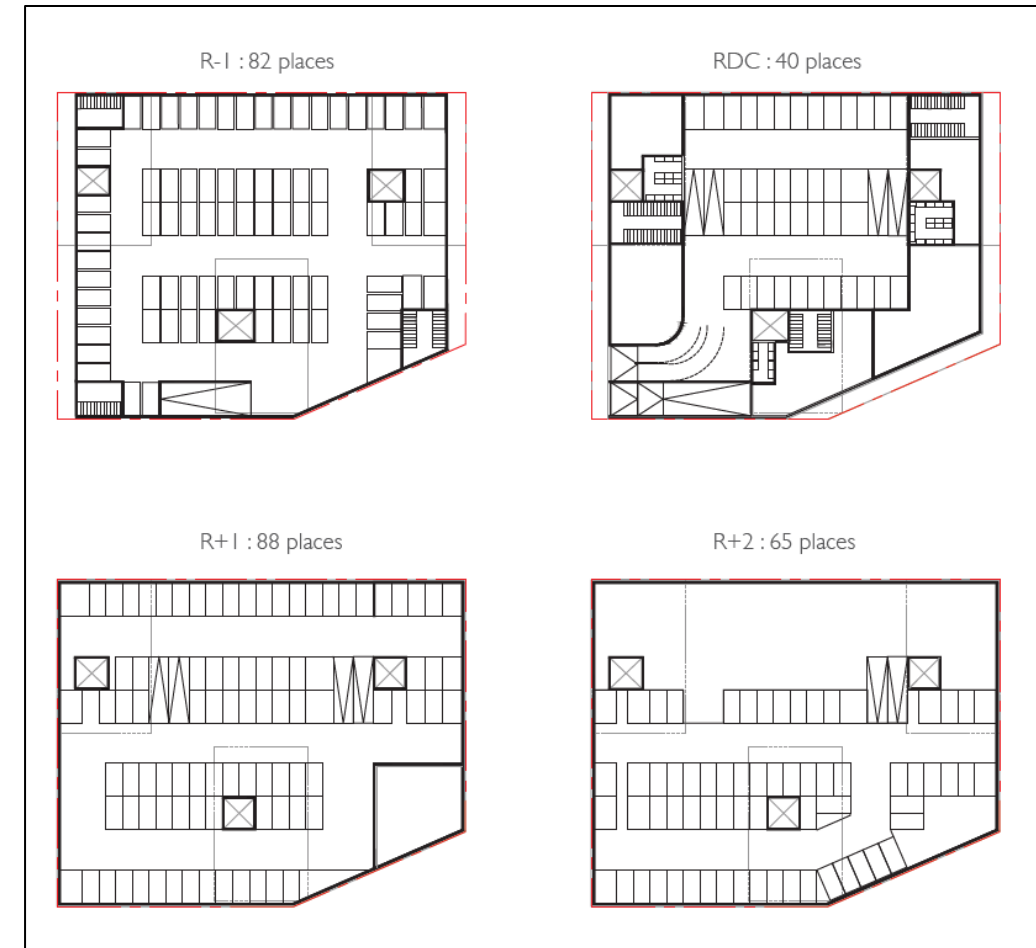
Plan d'aménagement du parking souterrain et du parking silo du lot H dédiés au stationnement
